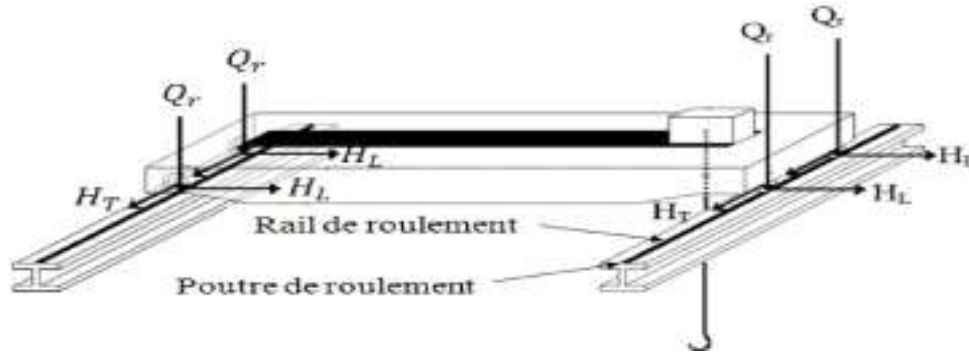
Les actions induits par le pont roulant sur la poutre de roulement.[5]
